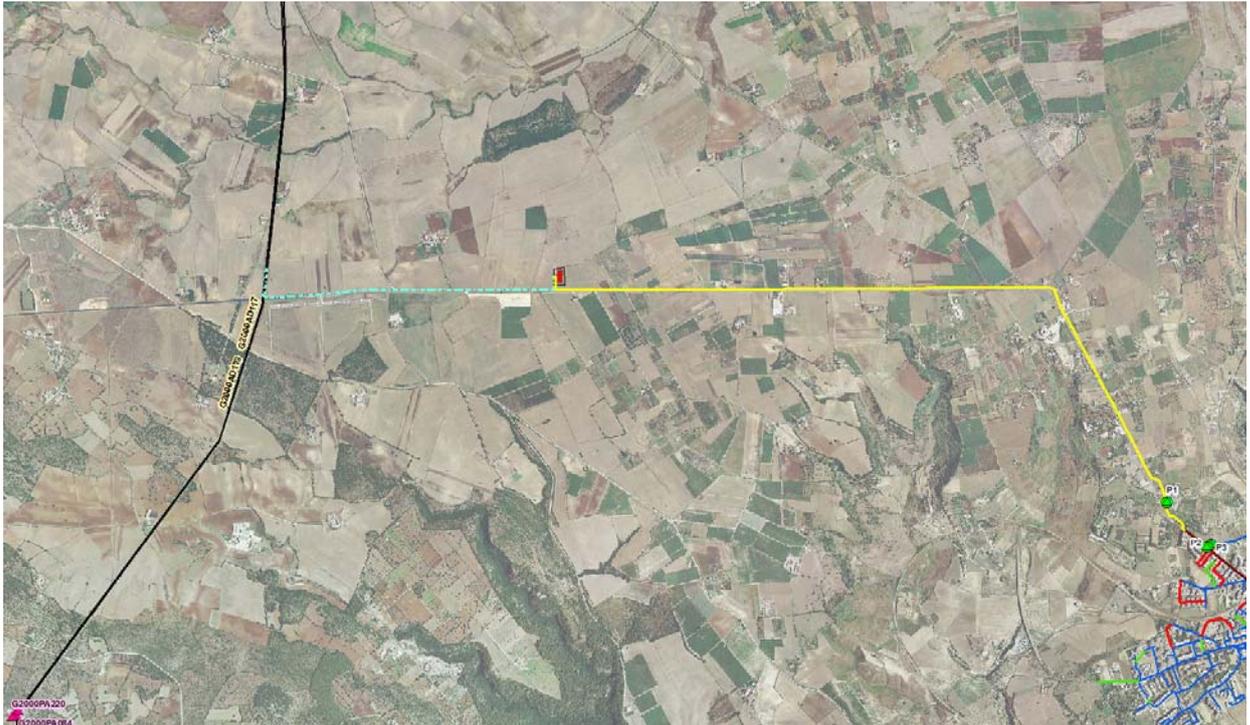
Interventi di progetto della rete idrica di adduzione: in giallo la suburbana.
